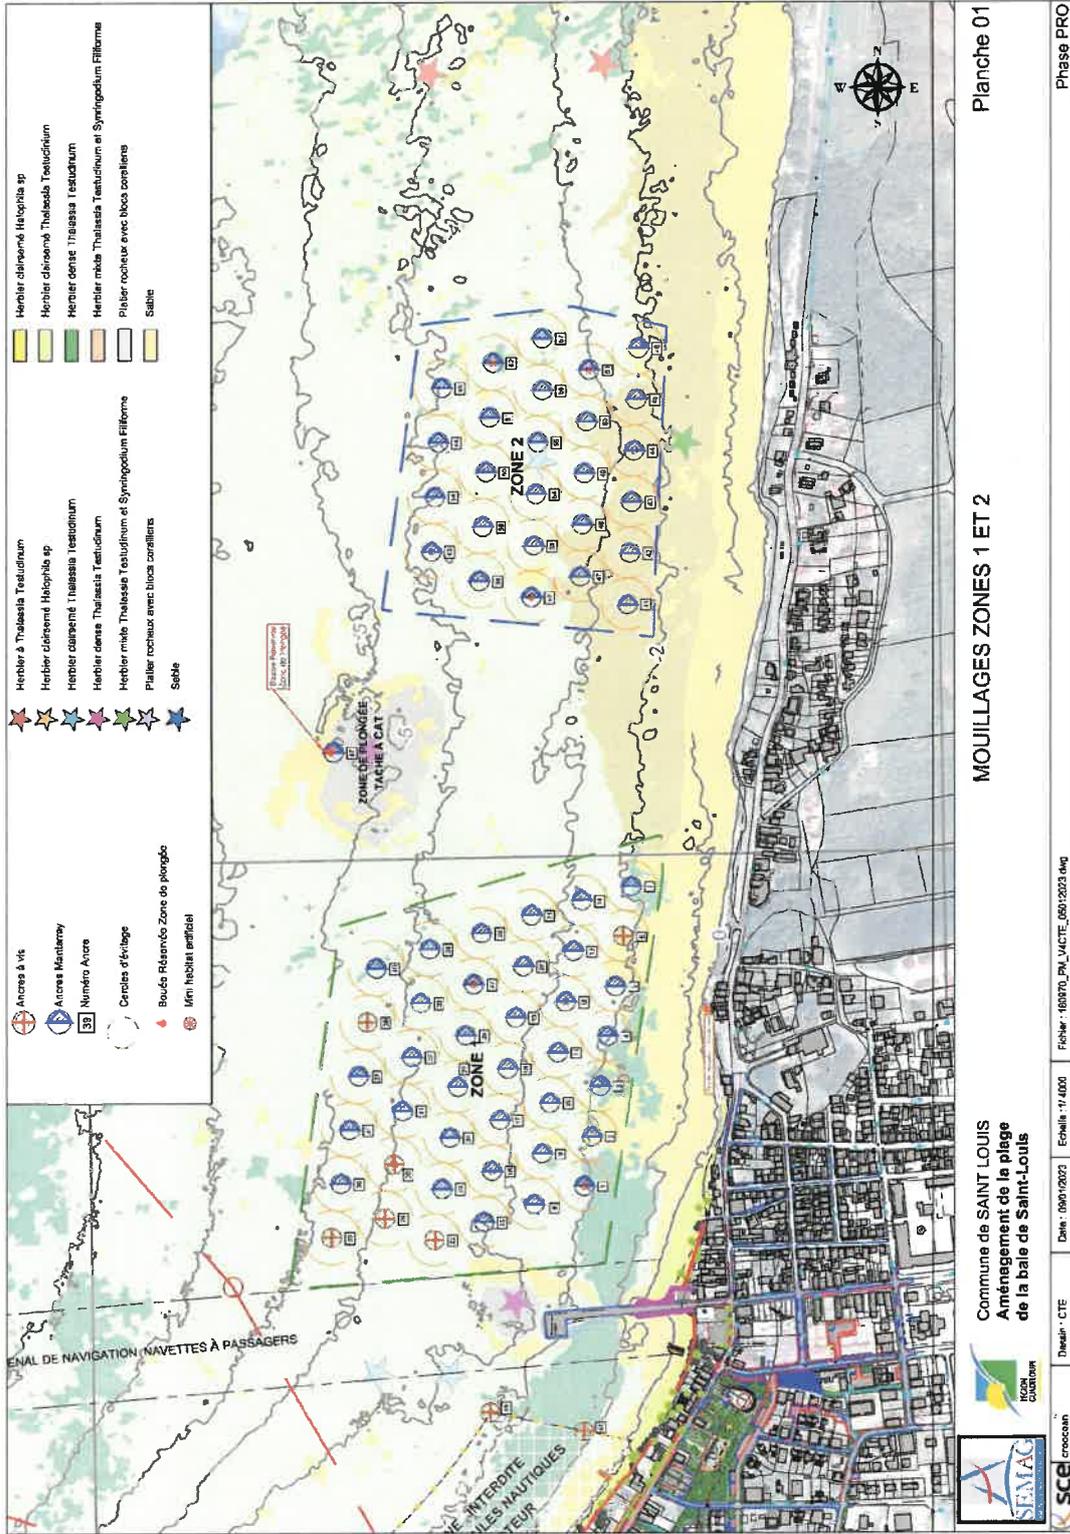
Plan de projet – Détail des 2 zones de mouillages
